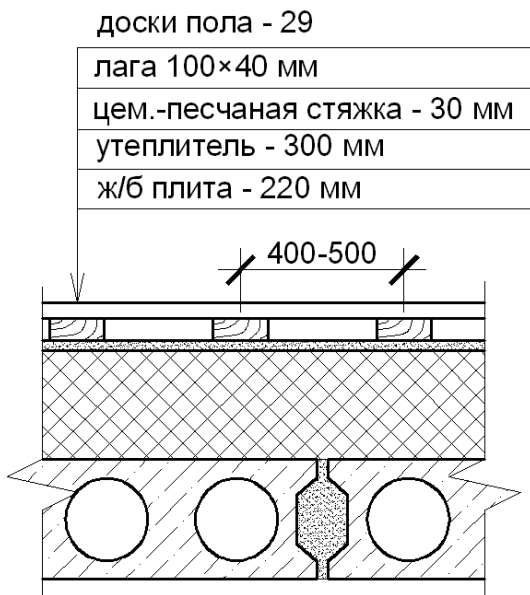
Перекрытие над неотапливаемым подвалом
